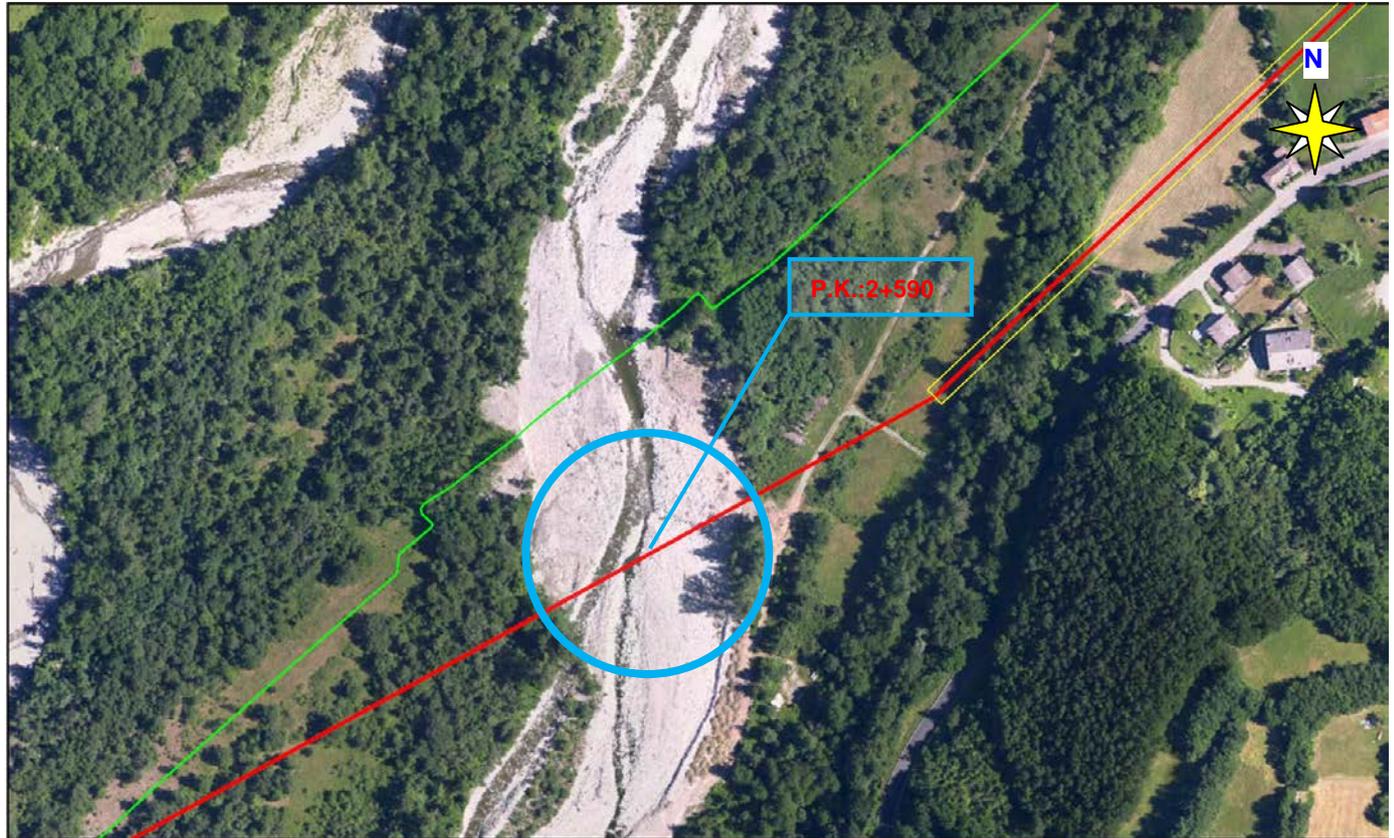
/A: Foto aerea dell'ambito di attraversamento
